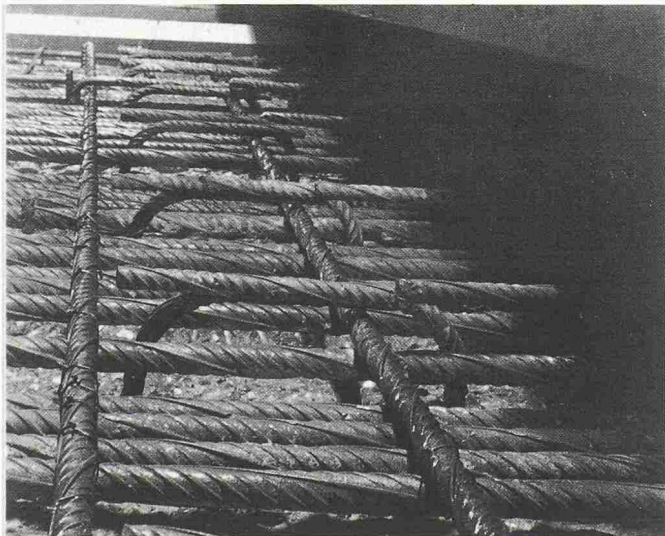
(links). Nach dem Betonabbruch (Bild 4) freigelegte Bewehrung der Schleusenwände (Rosa)
